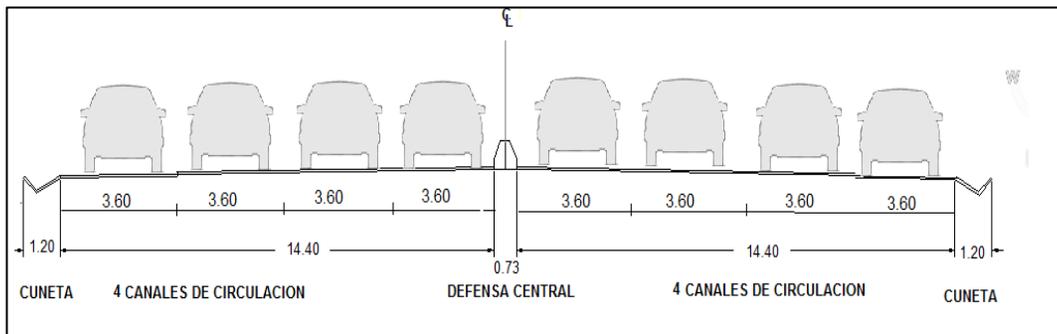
Sección transversal tramo Santa Cecilia – Los Cortijos. Fuente: Adaptación propia.
